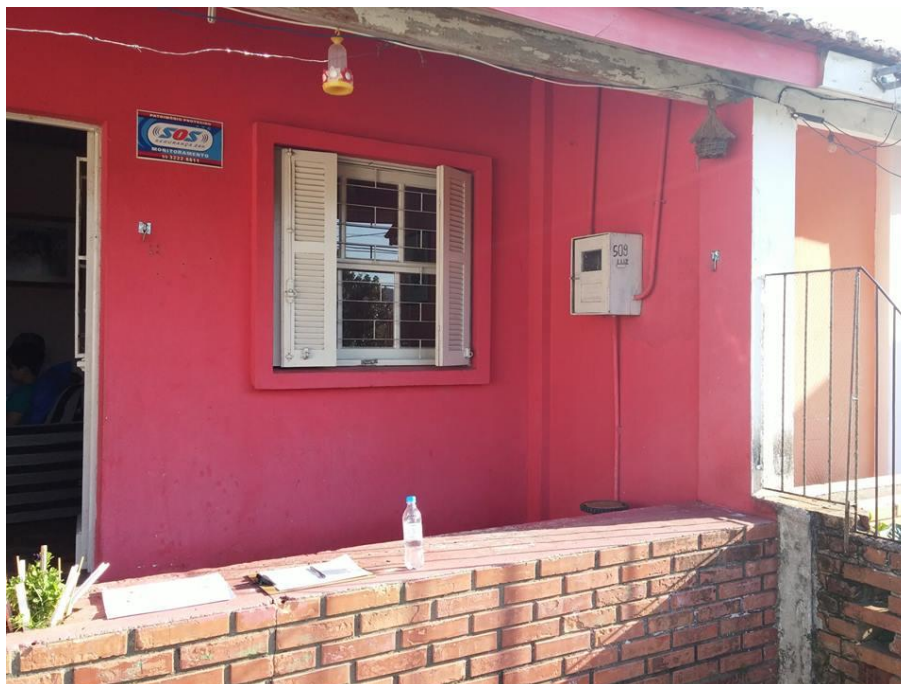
detalhe da deterioração por água e microrganismos no tijolo maciço e nas madeiras do telhado.
